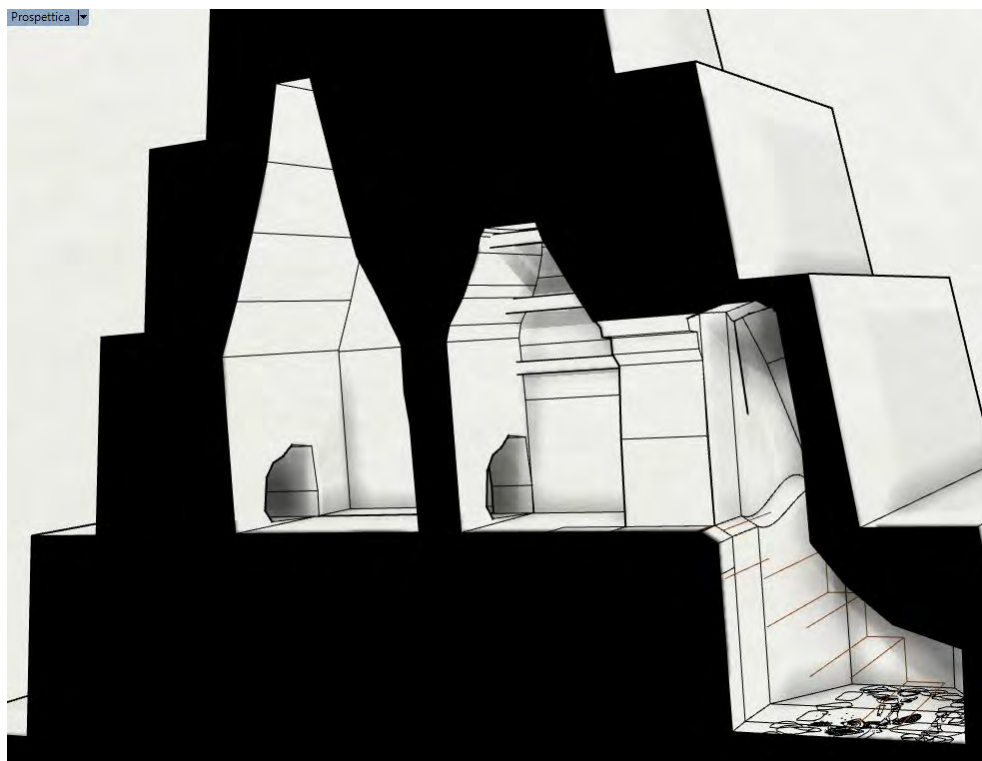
Reconstrucción hipotética de la segunda etapa constructiva de la Estructura 11K12, vista del saqueo este (A-1) que atravesó las cámaras abovedadas, proyectando las gradas cortadas y el Entierro 13. (Dibujo: M. Stefani, 2014)
